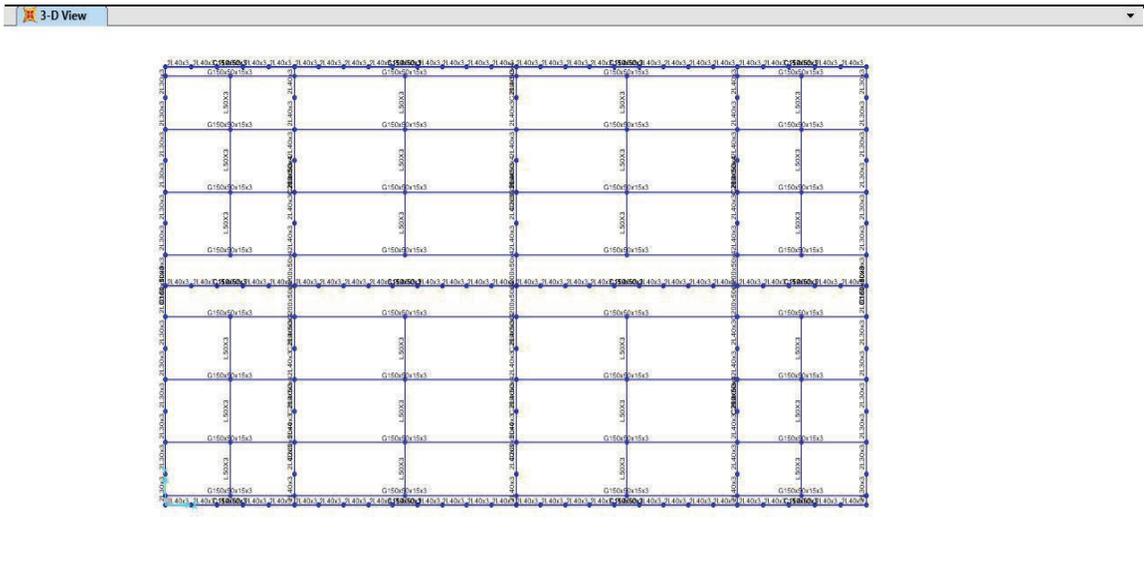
Planta de Miembros de Cubierta–Relación de Esfuerzos en Vigas. Ref. 8
